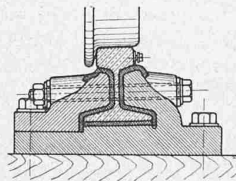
und 11. Isoliertes Schienenstück mit Stahlguss-Lasche.
